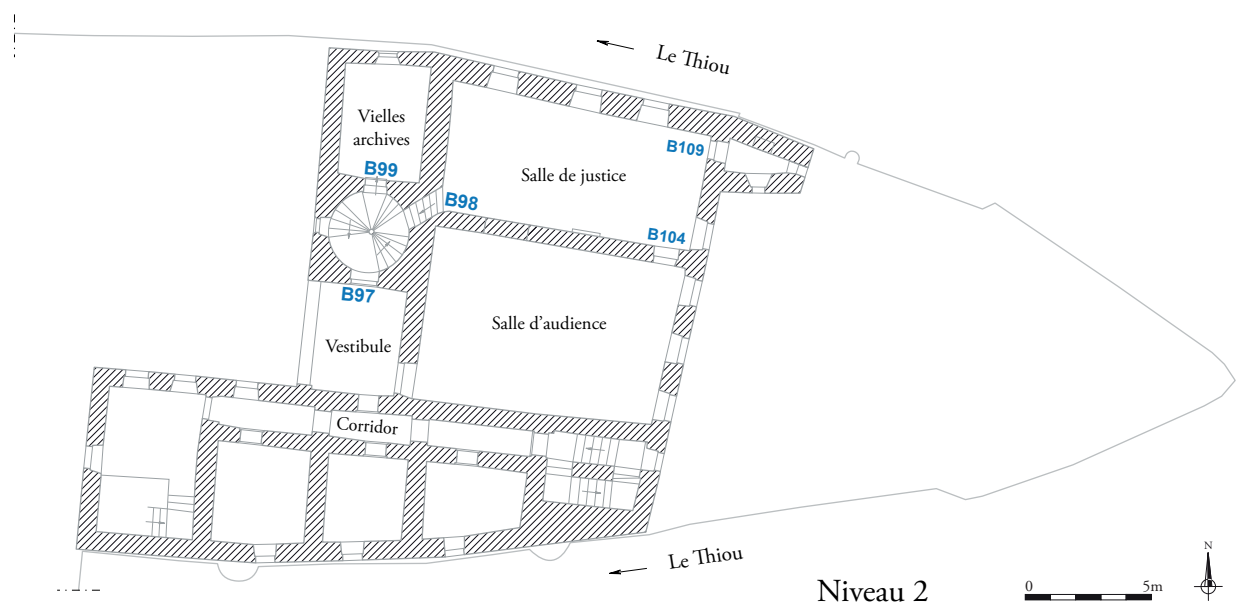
Plan général du site - Localisation des Unités de construction - éch. 1/300.
